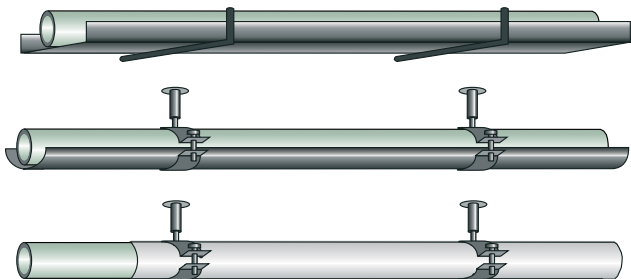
Проводка трубопроводів і труб STABI O2 у жолобах
